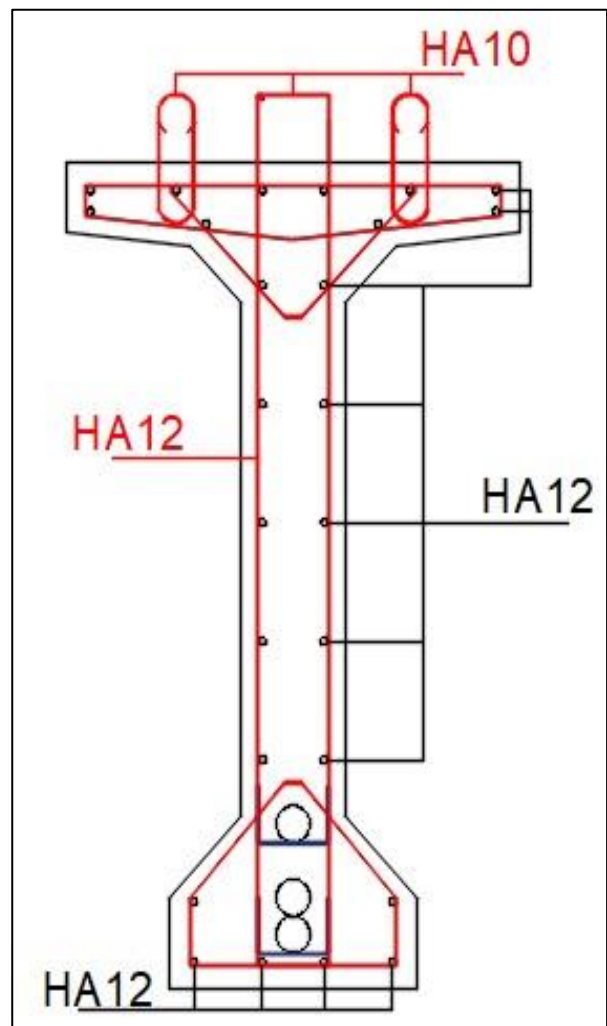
Ferrailage de la poutre à mi-travée
